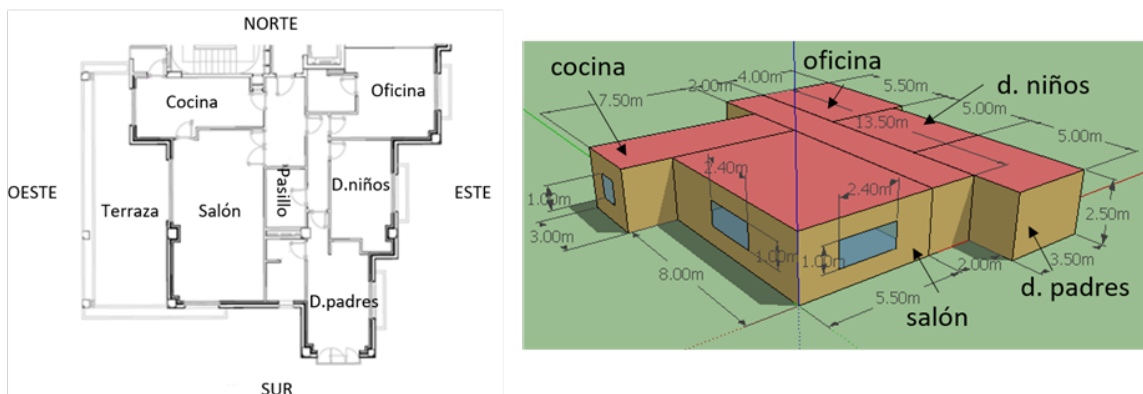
Planta y vista 3D de la vivienda utilizada en la simulación
